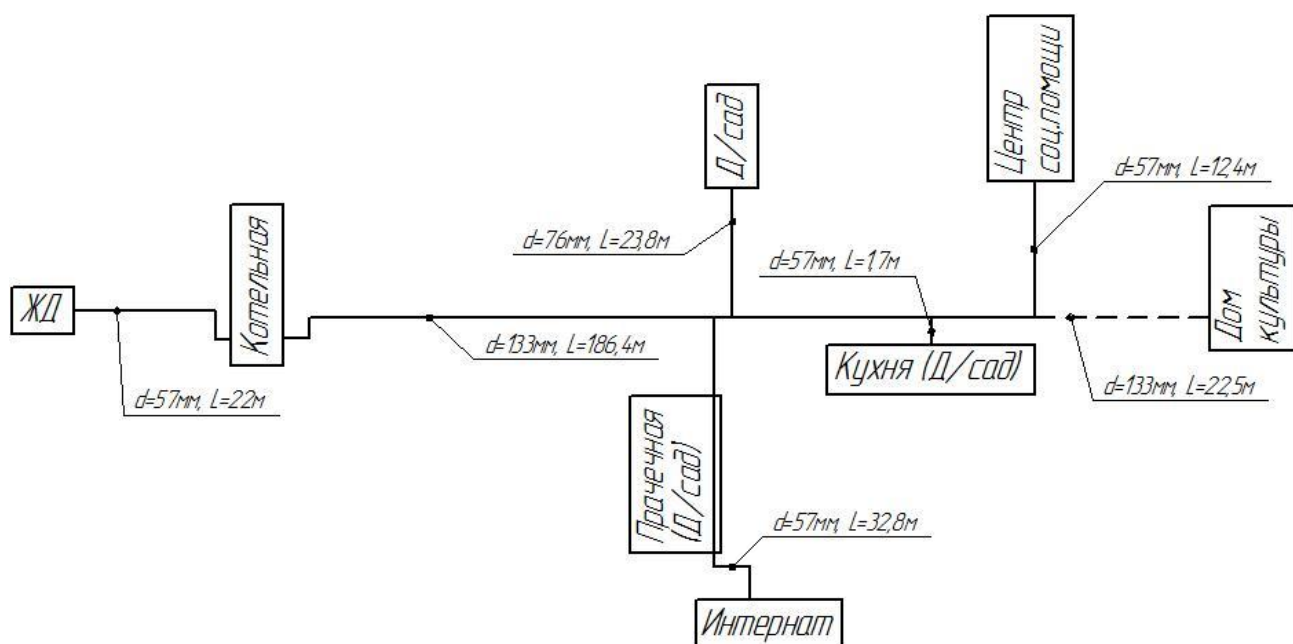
Схема тепловых сетей котельной №3
